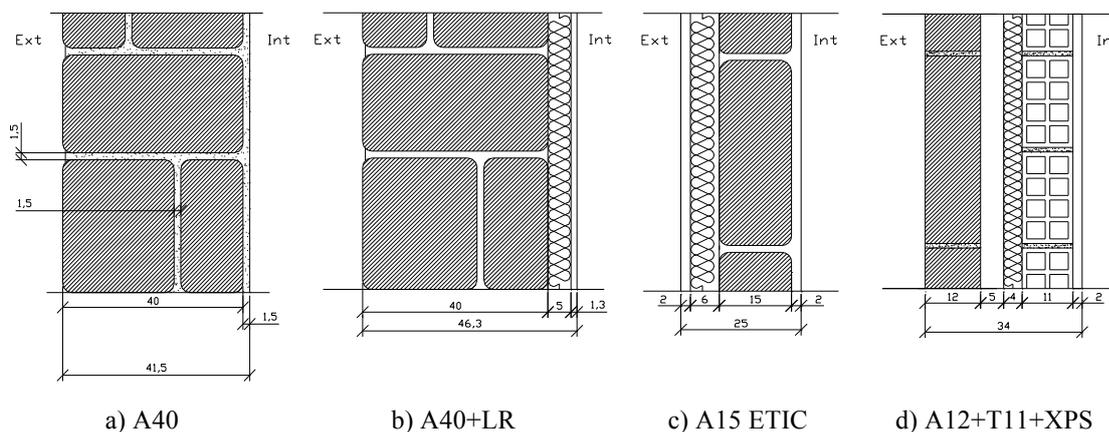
Secção tipo de paredes de alvenaria em pedra: (a) simples estrutural tradicional; (b) simples com isolamento interior; (c) simples com isolamento exterior (sistema ETIC); (d) dupla com pano interior em tijolo furado.
